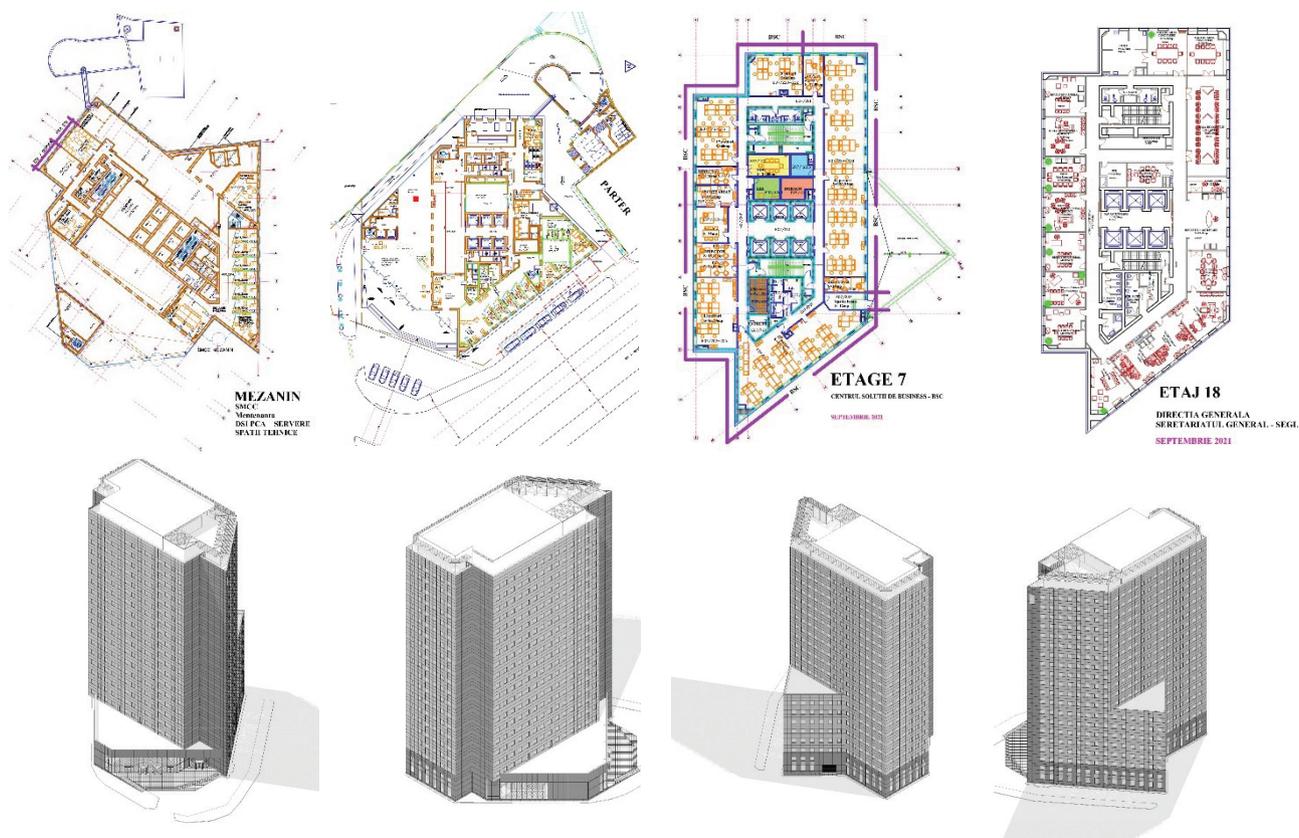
Anvelopa exterioară constă în sistem de fațadă cortină pe fațadele F1, F2a, F3, F4, F4', F7; fațadă ventilată pe F2b, F2c, F4, F8a, F8b; și fațadă de sticlă structurală pe fațadele , F5 și F6 /External envelope consists of Curtain wall system on the F1, F2a, F3, F4, F4', F7; Ventilated facade on F2b, F2c, F4, F8a, F8b and structural glass facade on F5, and F6.
